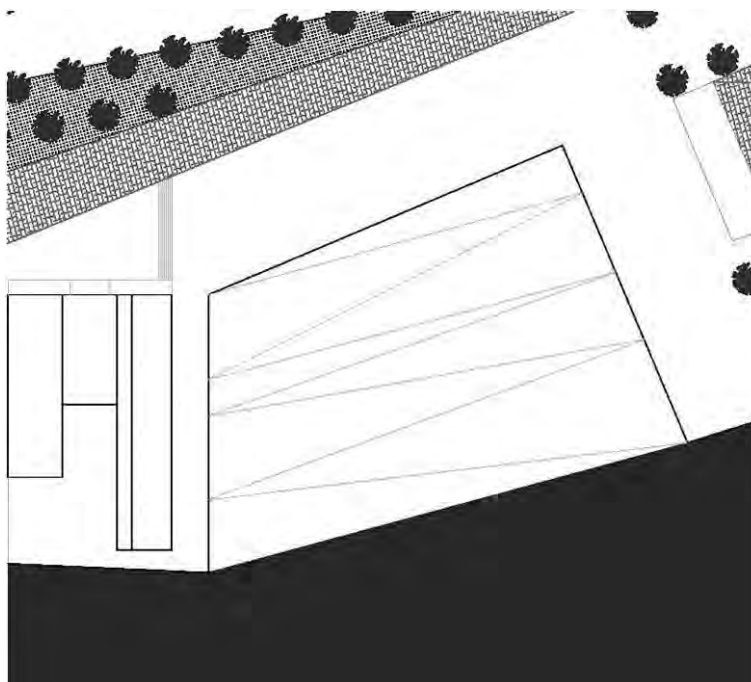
Desenho em planta, pormenor praia fluvial. (Ilustração nossa, 2011)
